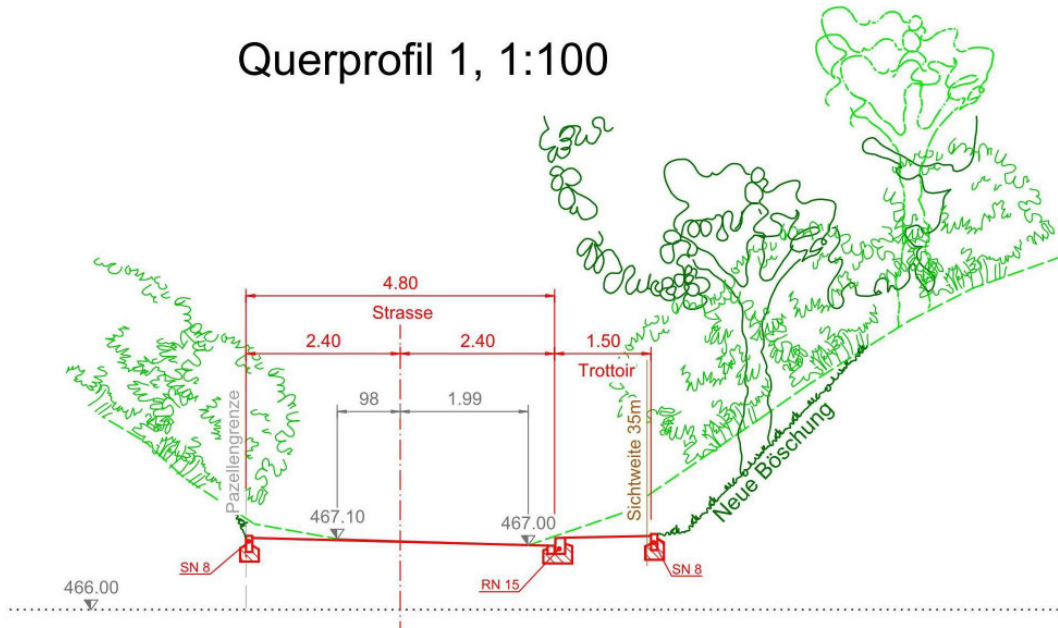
Anpassungen Wilergasse, Querprofil unterhalb der Einfahrt, Richtung Kreuzgasse
